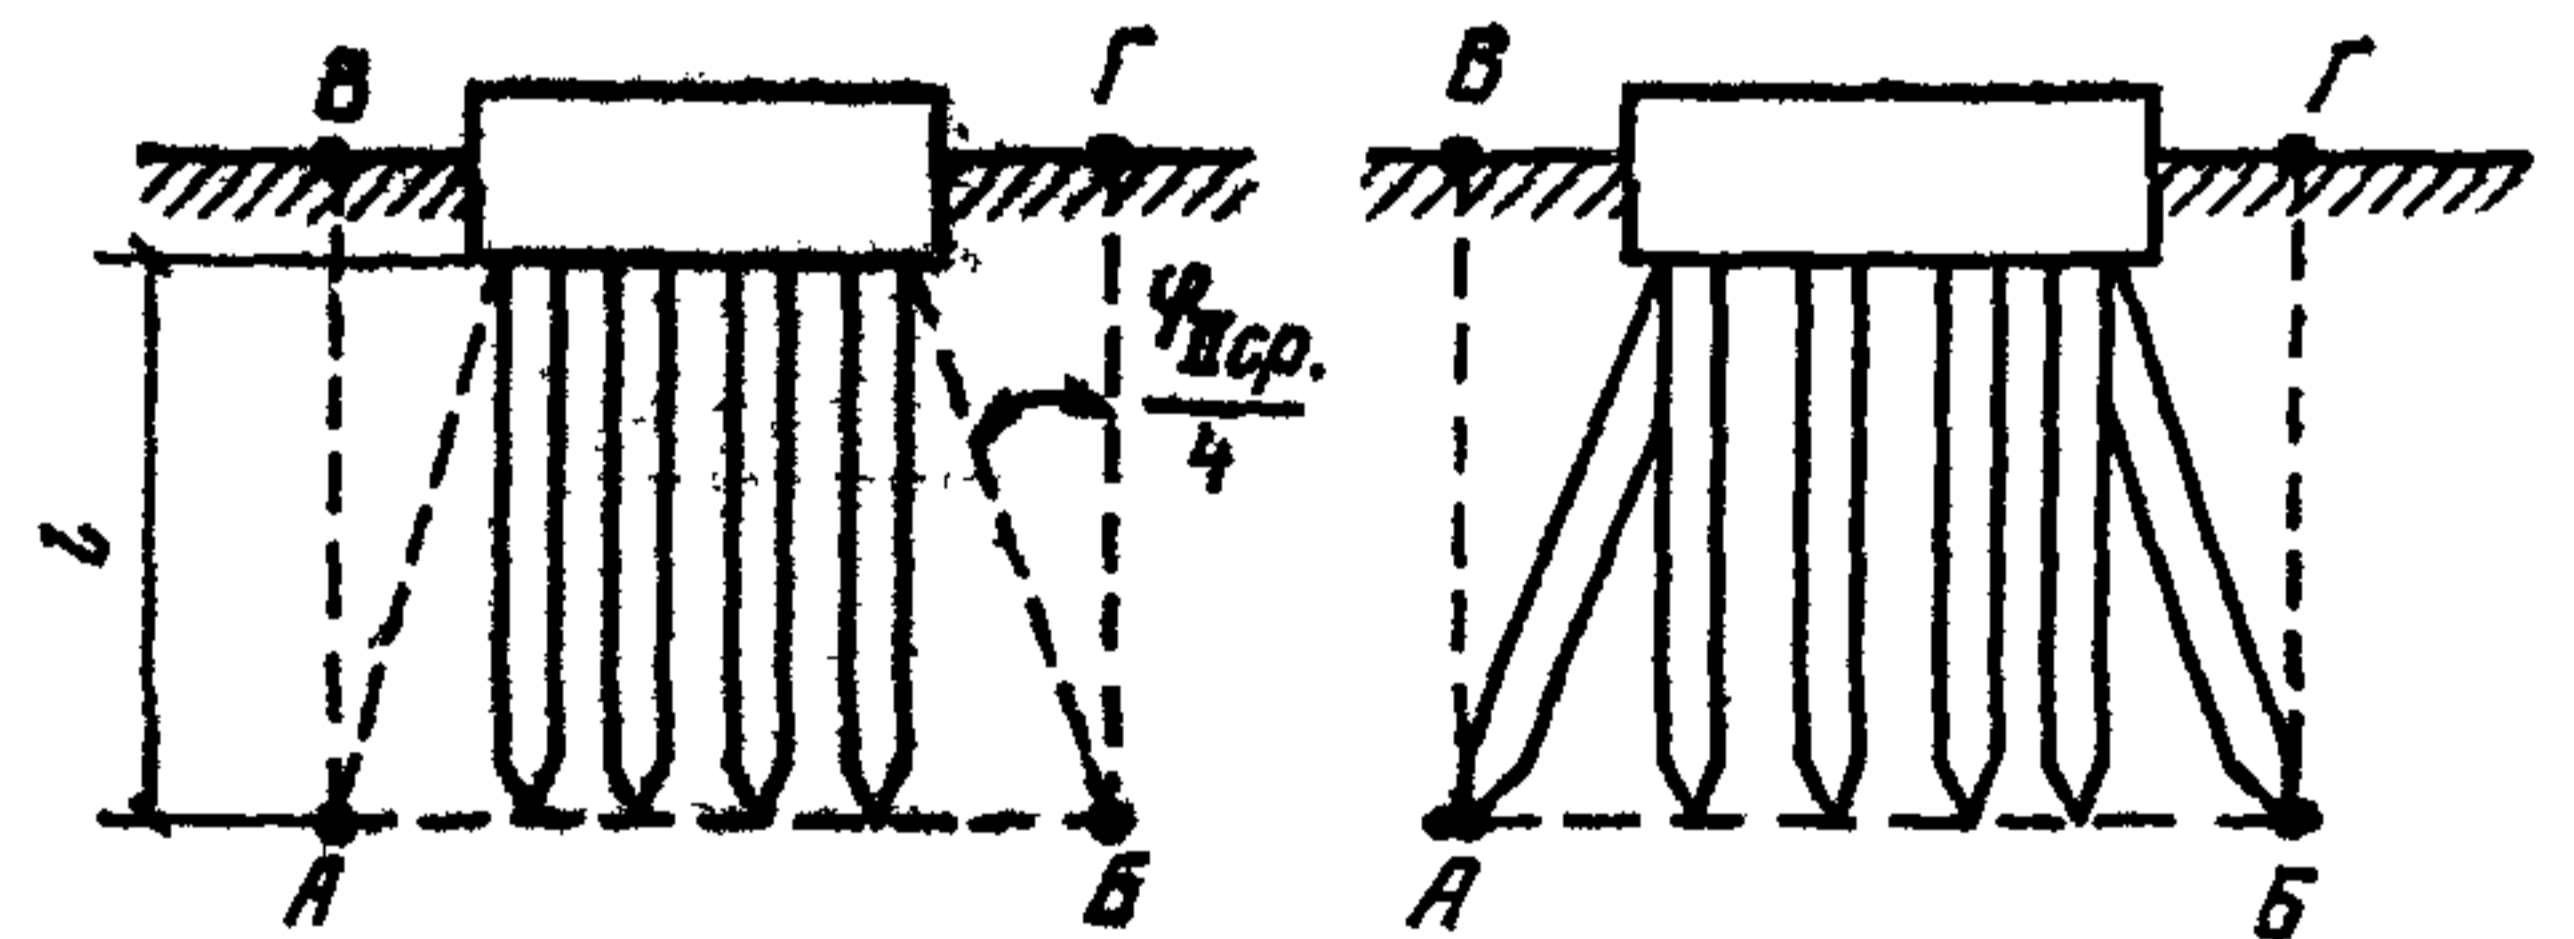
(1). Схема определения границ условного фундамента при расчете осадок свайных фундаментов
